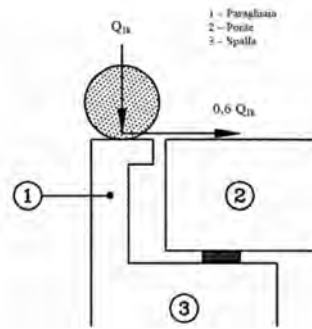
Carichi da traffico su muri paraghiaia
